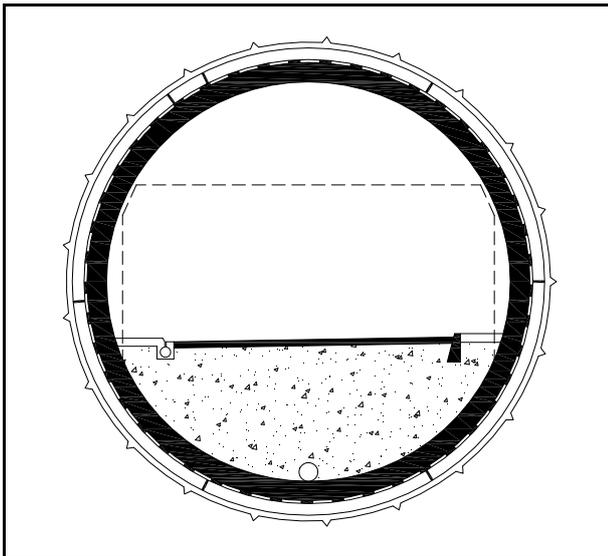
2-schalige Konstruktion mit geschlossener Sohle
